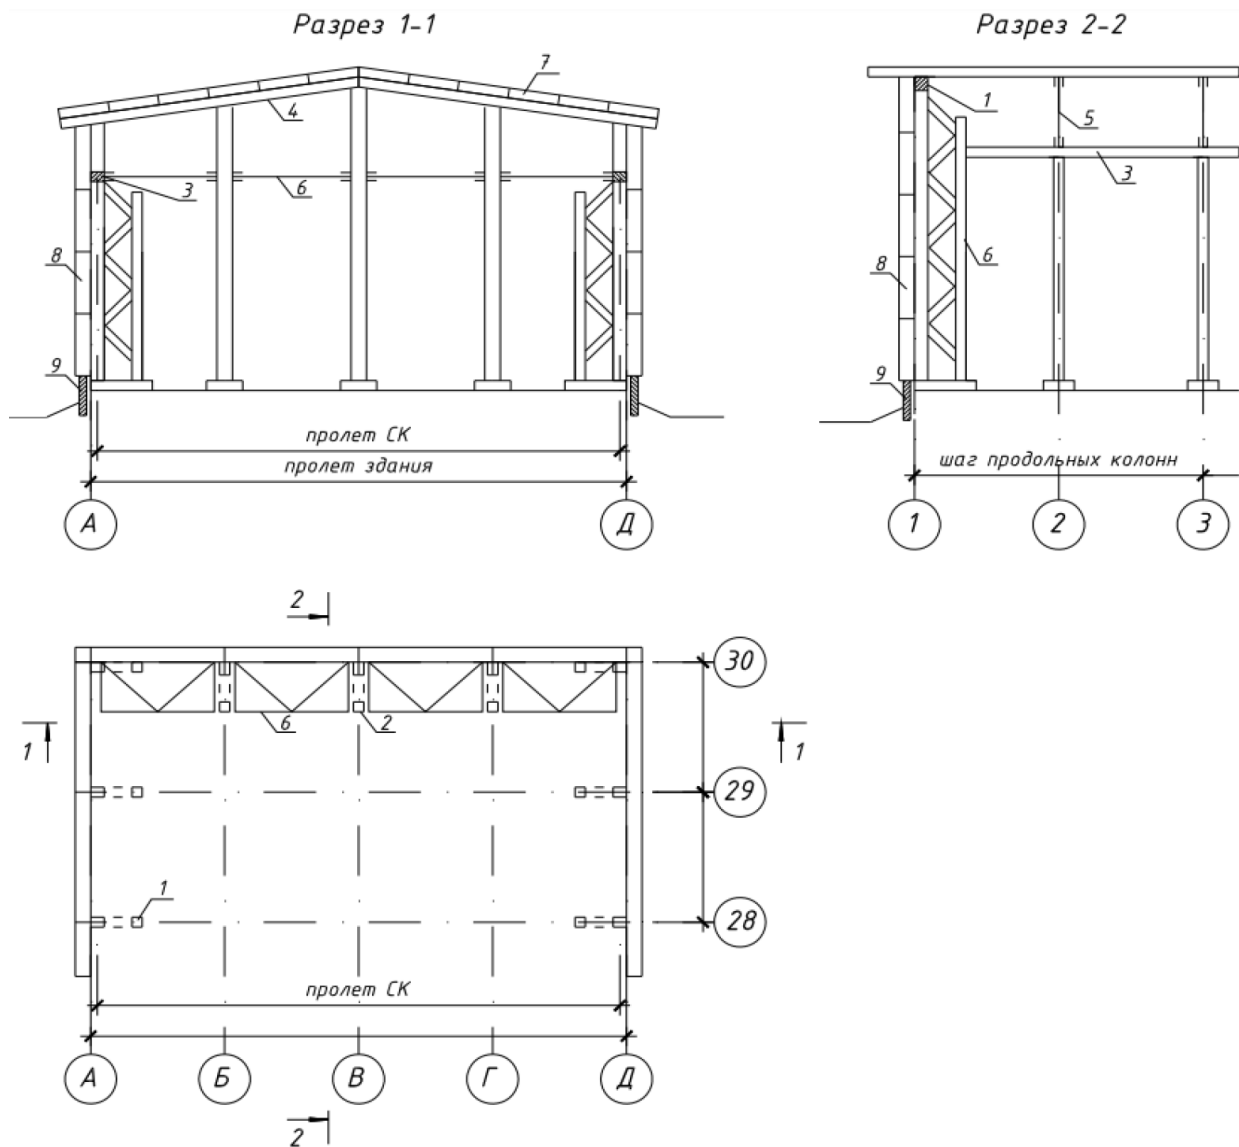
Проект здания лесопильного комплекса, полностью выполненного из деревянных материалов: 1 – основная колонна; 2 – колонна торцевого фахверка; 3 – обвязочный брус; 4 – балка; 5 – вид сбоку на двутавровую стропильную балку; 6 – сборная конструкция колонны на металлических связях; 7 – сборно-щитовой утепленный элемент покрытия с верхней конструкцией из обработанной деревянной щепы (деревянная черепица на настилах); 8 – сборные щиты стеновых панелей; 9 – высокий оголовок свайного или стоечного фундамента
